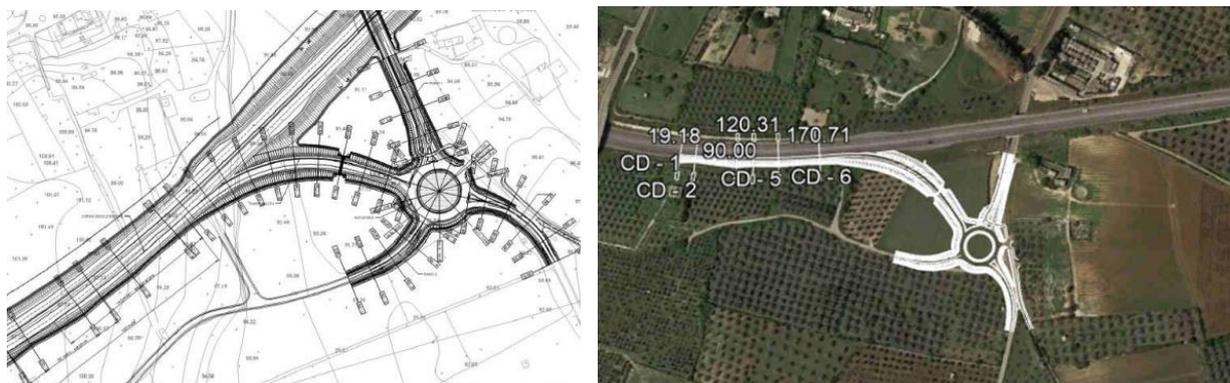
Stralcio planimetrico di progetto (a sinistra) e fotoinserimento dello svincolo (a destra) (Fonte: Lista di controllo)
